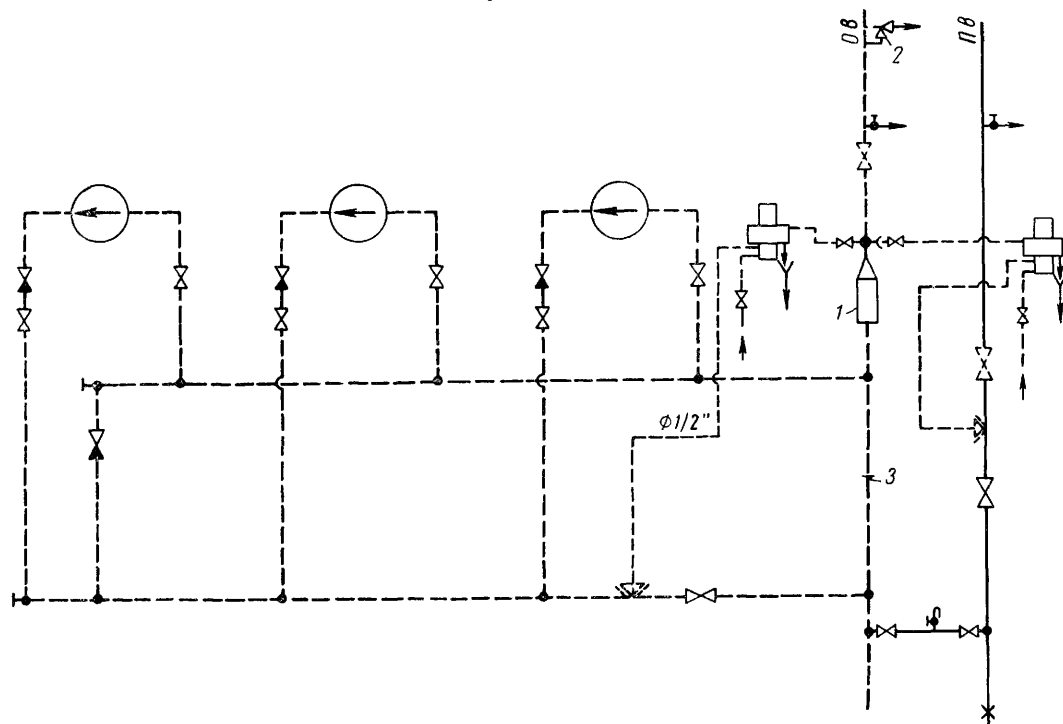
Схема подкачивающей насосной на обратном трубопроводе
